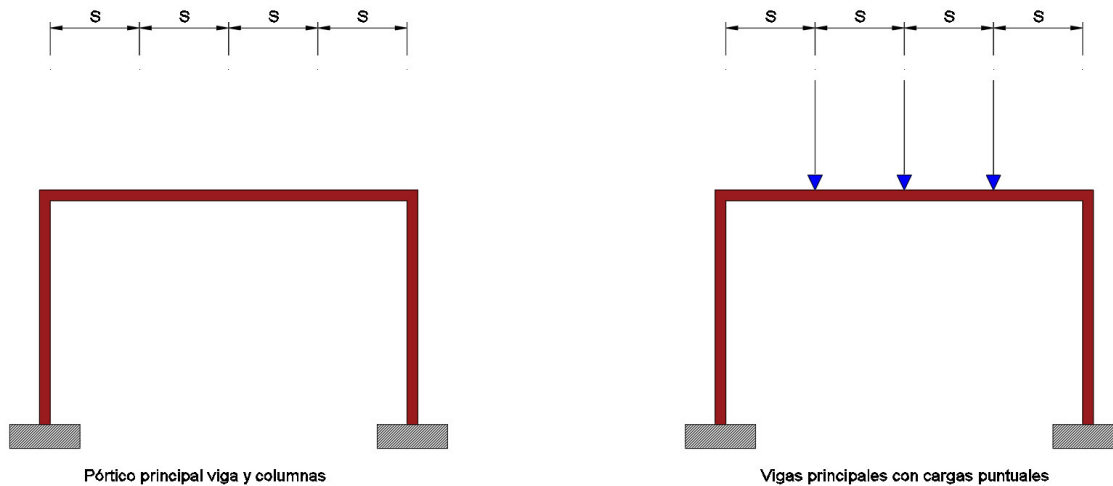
Vigas principales sometidas a fuerzas generadas por las vigas secundarias.
